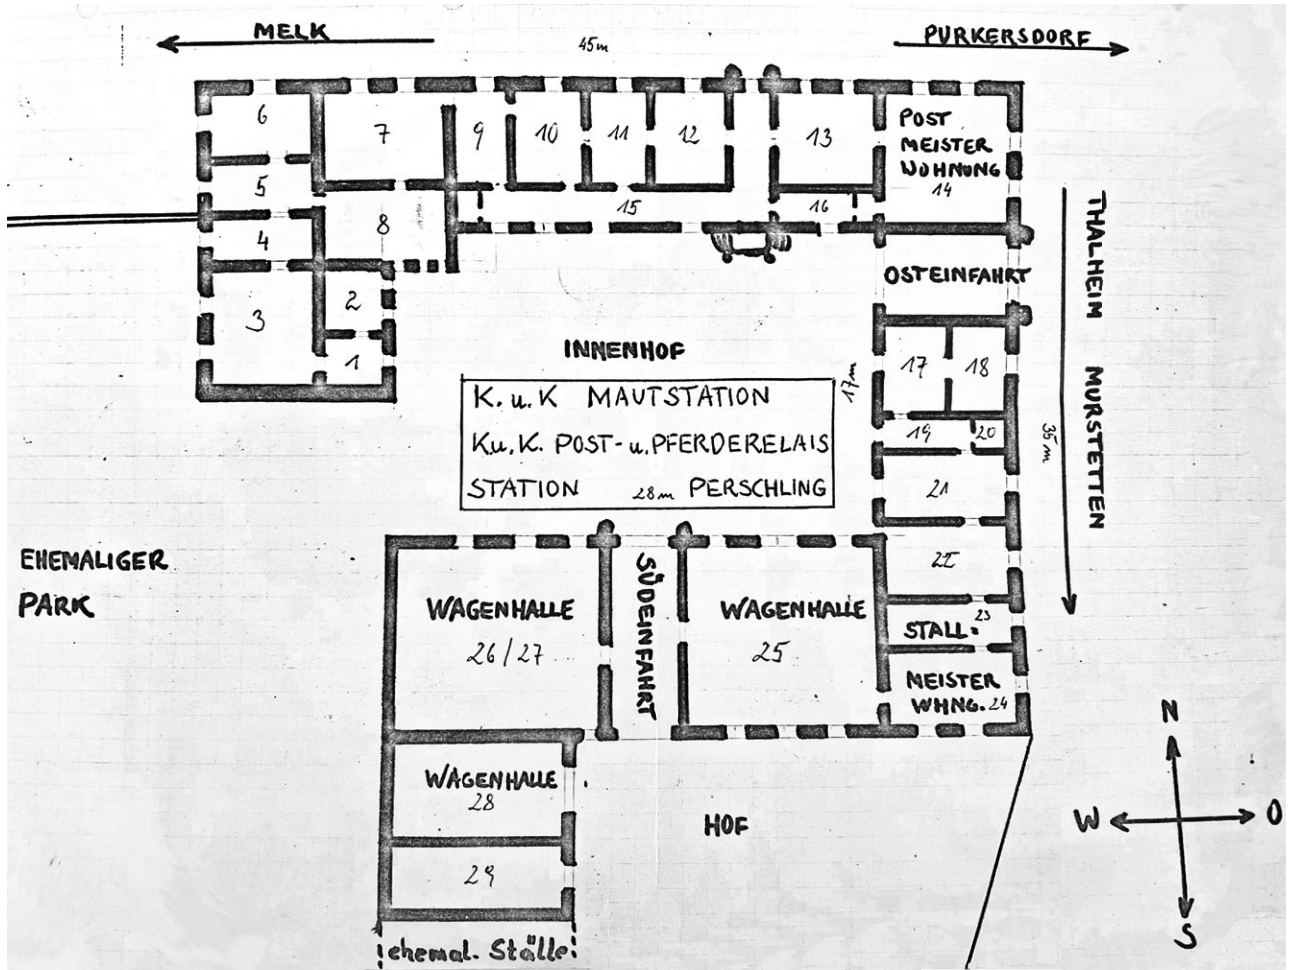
Perschling- Posthaus, alter Grundriss
